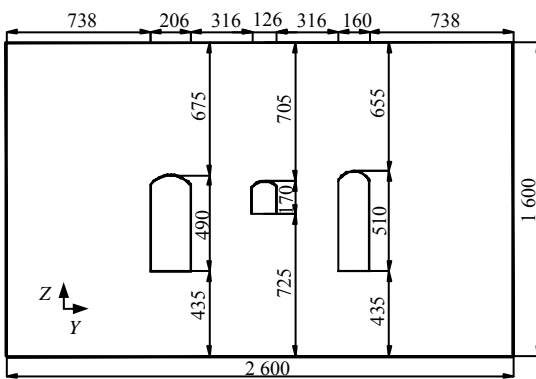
模型在 Y、Z 方向剖面图 (单位：mm)
